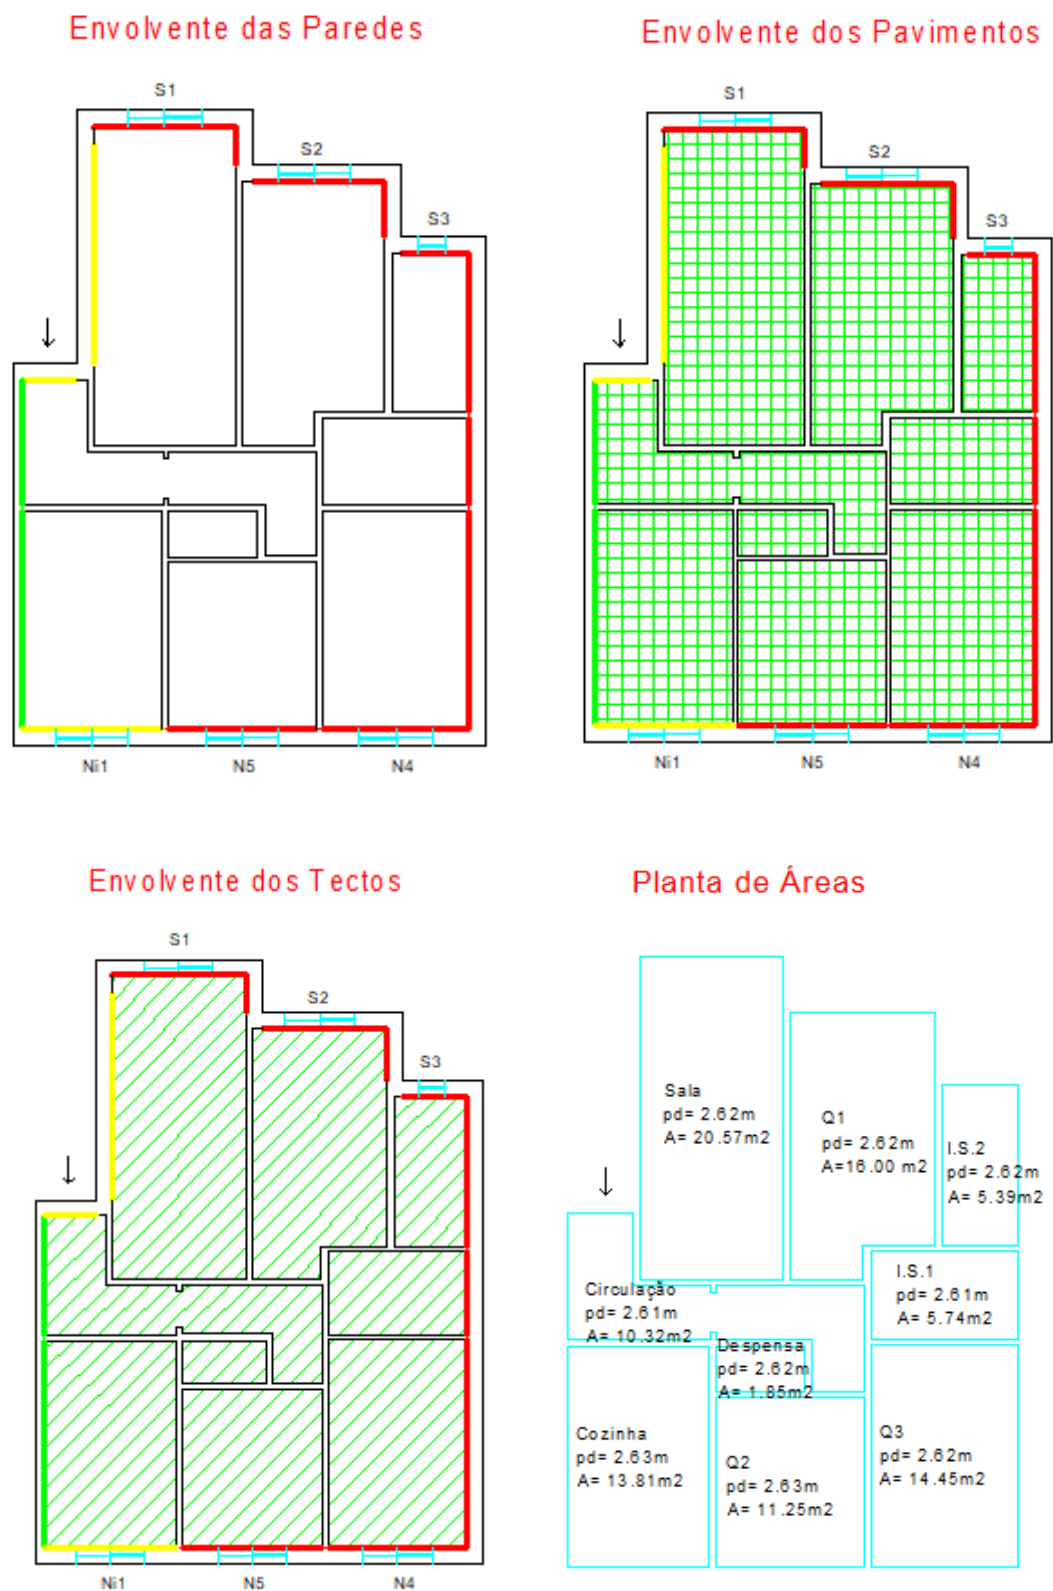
Planta da fracção com a delimitação das envolventes e planta de áreas (caso 2 - sem escala).
